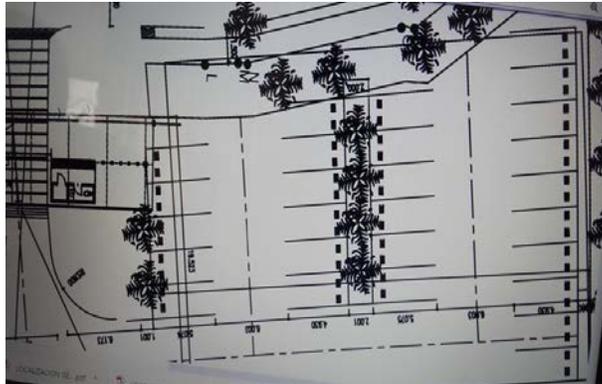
Plano de la superficie donde se instalaría el parqueadero propuesto.
